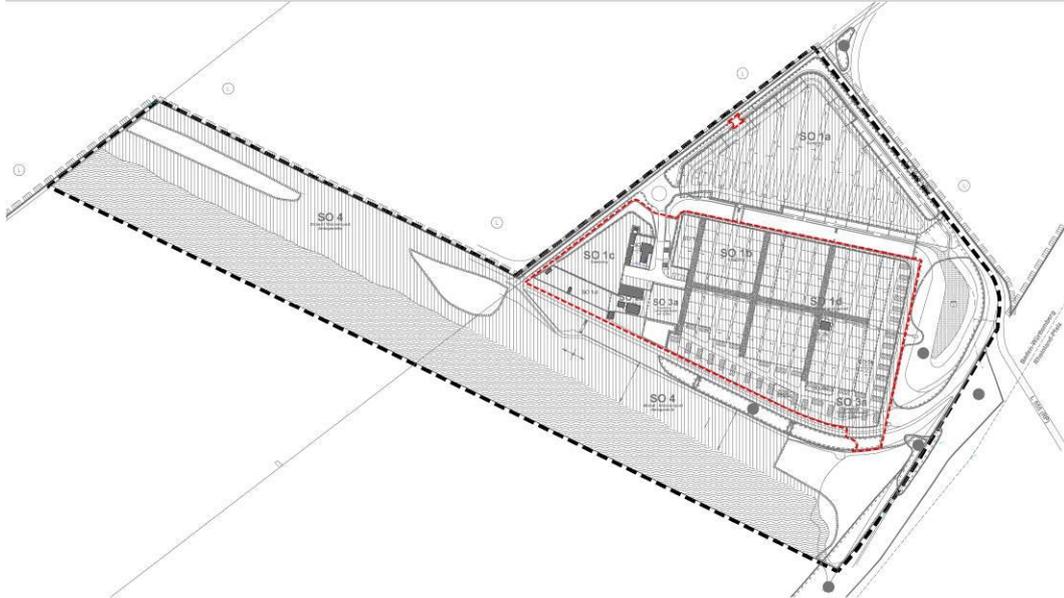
3. Änderung des Bebauungsplans „Koller“
